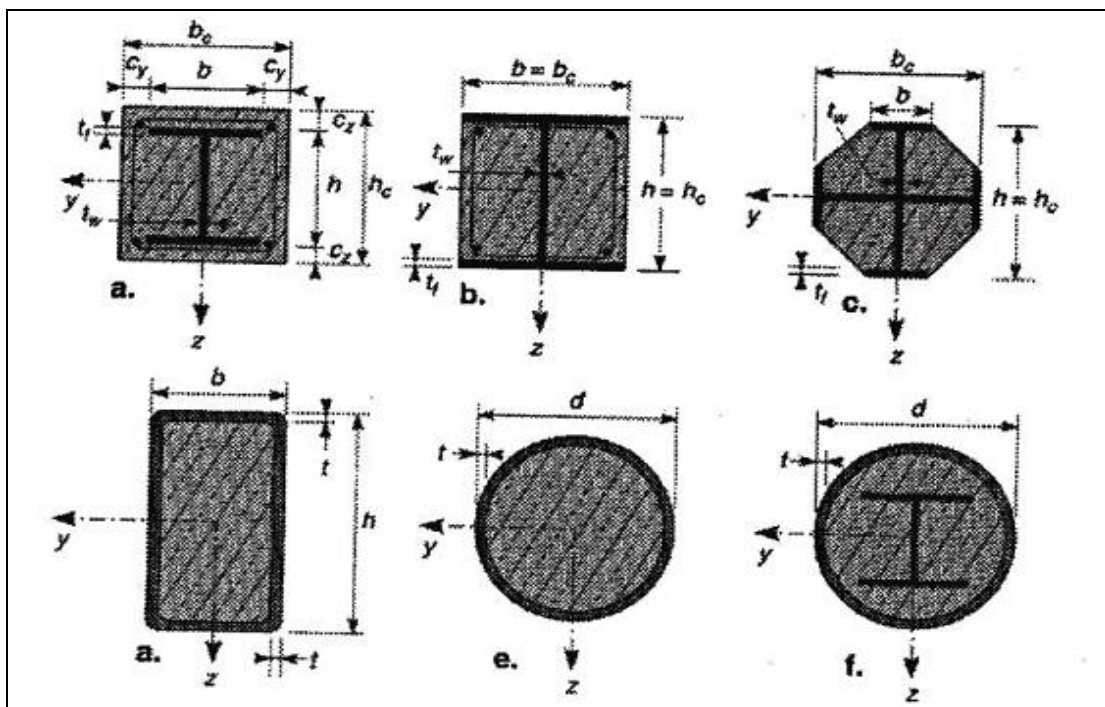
Exemples typiques de sections transversales de poteaux mixtes, avec symboles.
